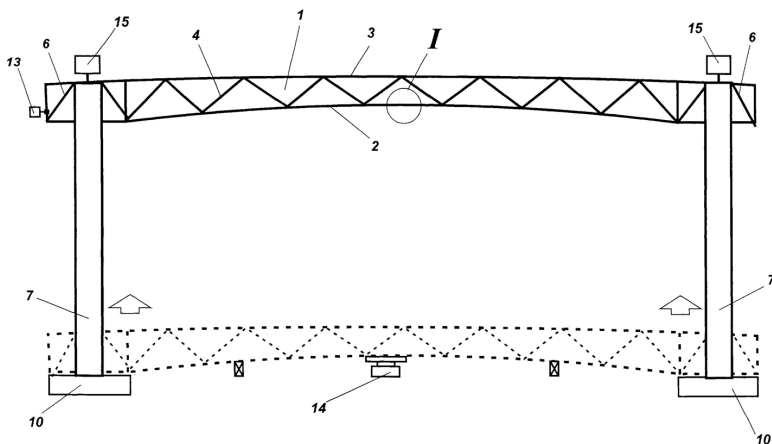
Ферма большепролетного здания в момент монтажа покрытия на неподвижные колонны [4], где: 1 – фермы покрытия; 2 – нижний пояс; 3 – верхний пояс; 4 – раскосы; 6 – несущие опорные узлы; 7 – колонны; 10 – проектный фундамент; 13 – лебёдка; 14 – подъёмные механизмы; 15 – система лебёдок.
